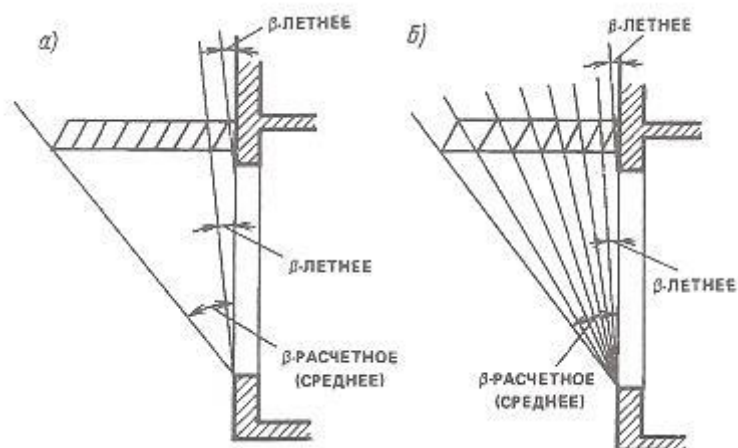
Конструктивные схемы решетчатых козырьков.
